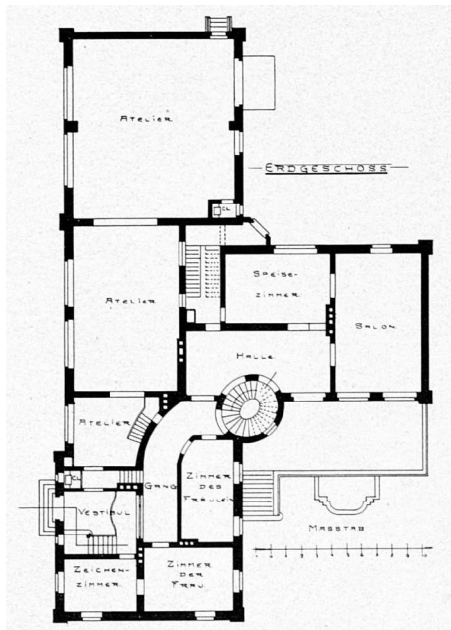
Wohnhaus von Adolf von Hildebrand, Grundriß Erdgeschoß.
